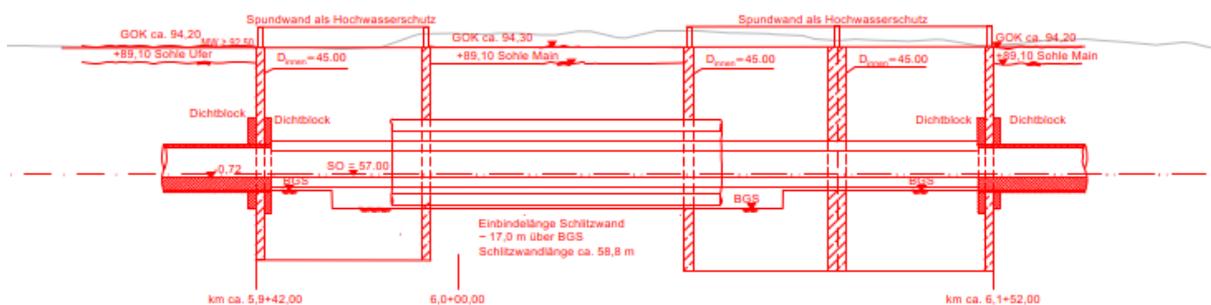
Längsschnitt Y-Bauwerk, 2gleisige Tunnelröhre
